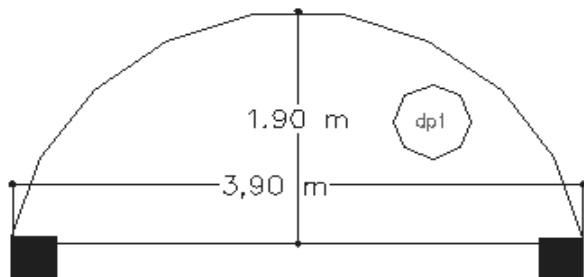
dalle pleine sur deux appuis terrasse inaccessible.
